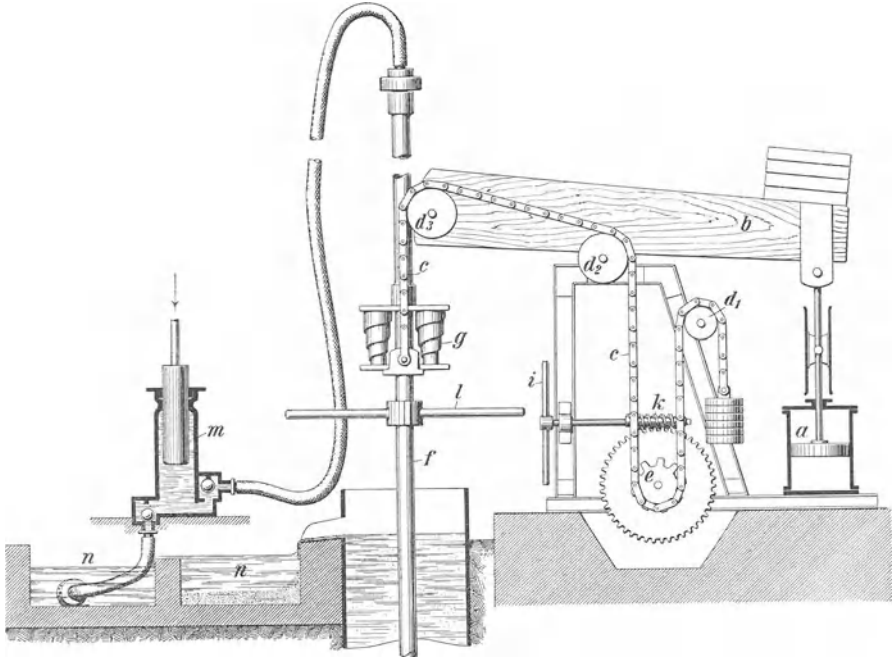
Schema einer Schachtbohrereinrichtung der Gewerkschaft Deutscher Kaiser.
